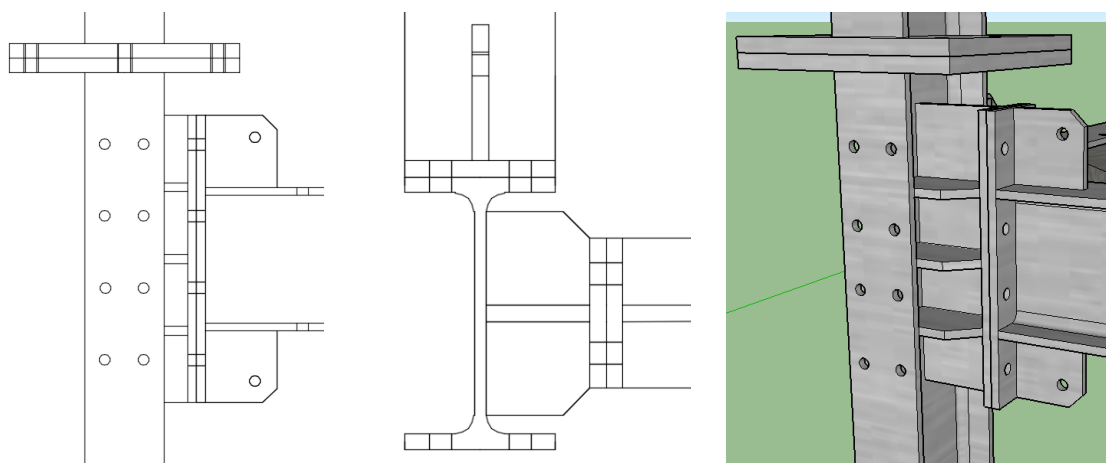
Pormenor de ligação do pilar com a viga - vista lateral a), vista de cima b) e vista 3D
